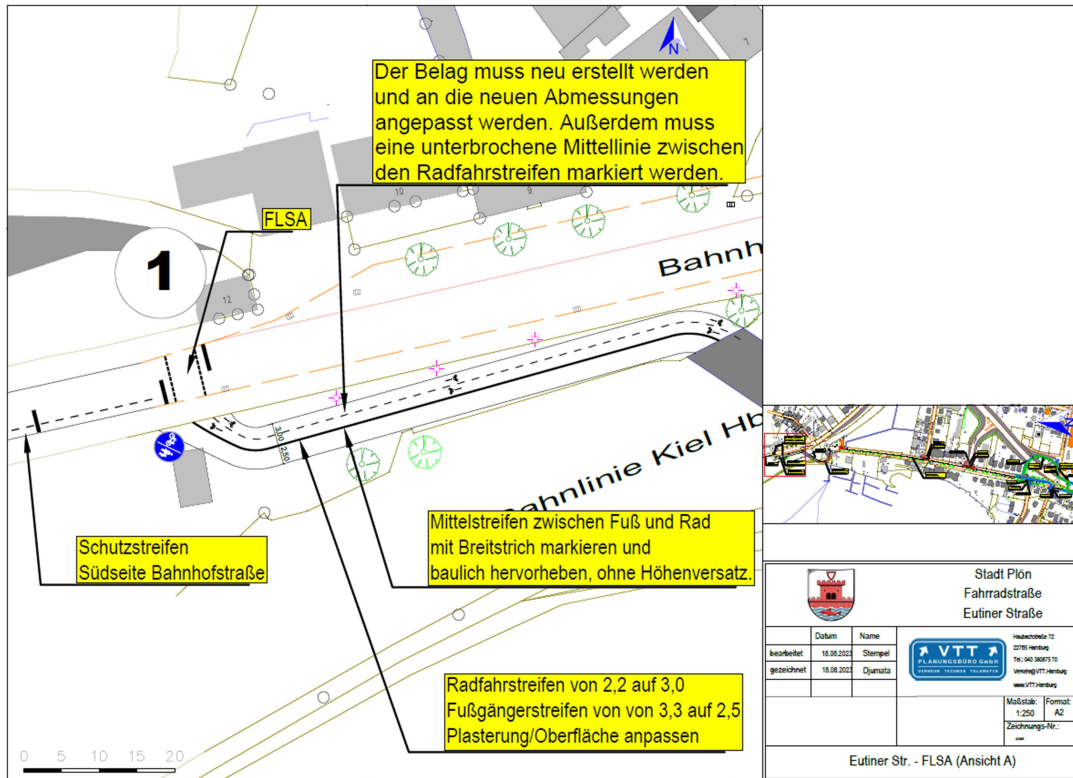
Abschnitt 1 - Anschluss Bahnhofstraße mit Rampe West Bahnhofstunnel mit separatem Fuß- und Radweg
